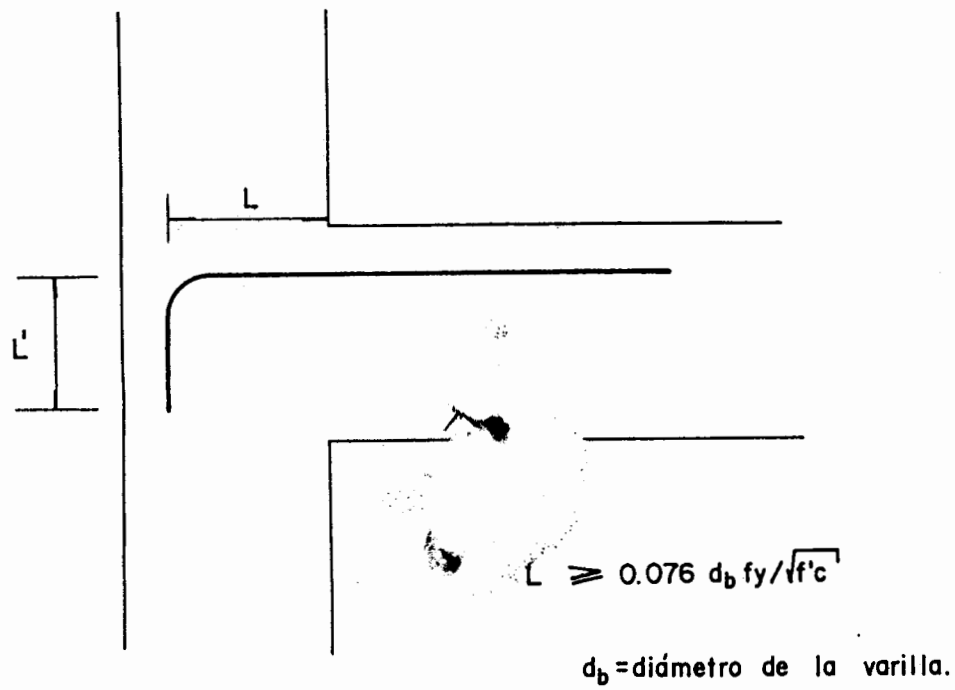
Anclaje del refuerzo longitudinal en vigas
